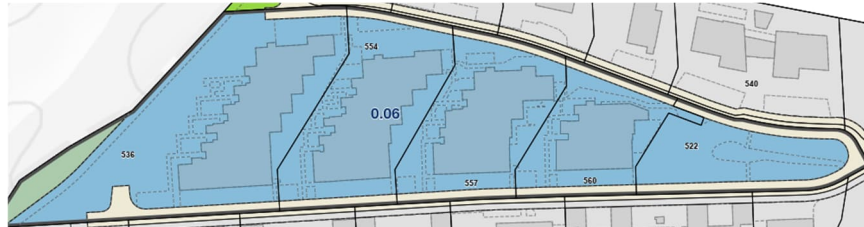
Sockelgeschosse als Nebenbauten, ÜZ_{NB} über gesamten Terrassenhaus-Perimeter
